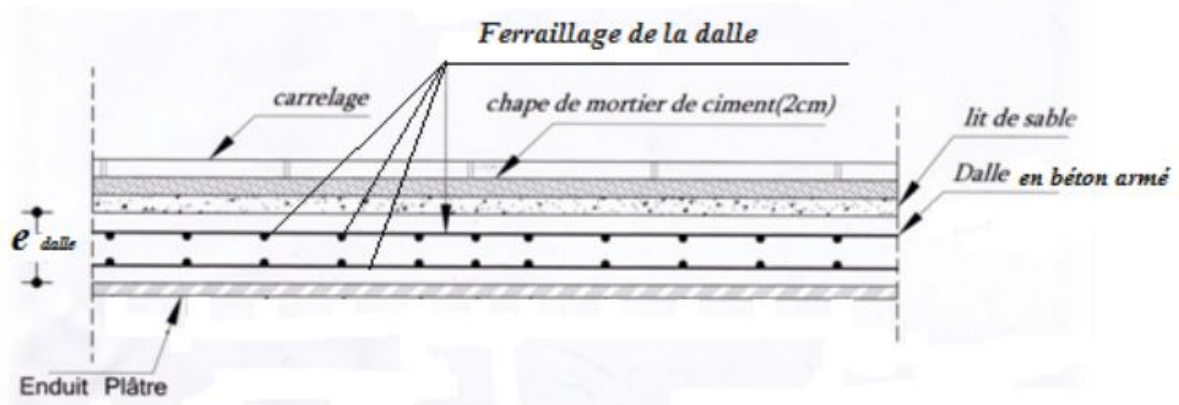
Détails d'un plancher en dalle pleine (plancher étage courant)
